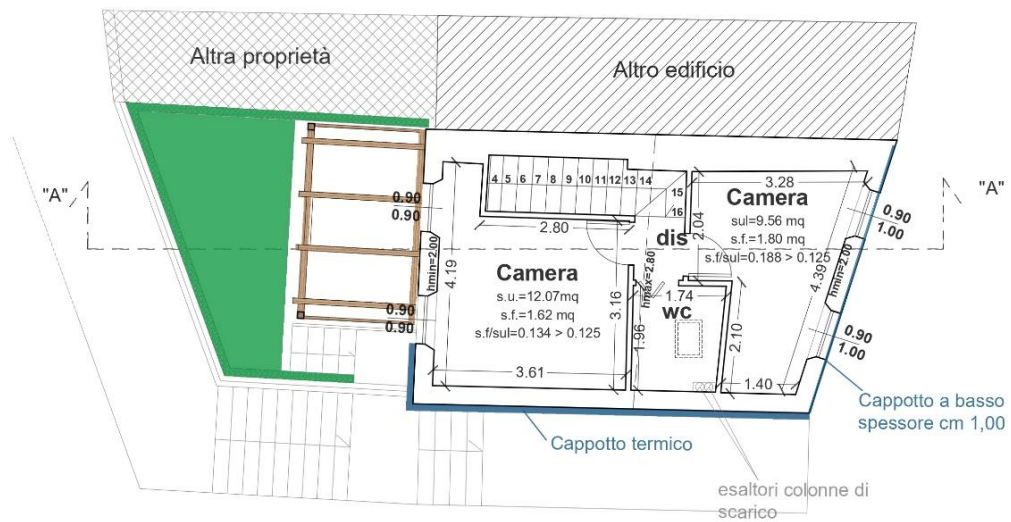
Stato futuro – Pianta piano Seminterrato e Terra
